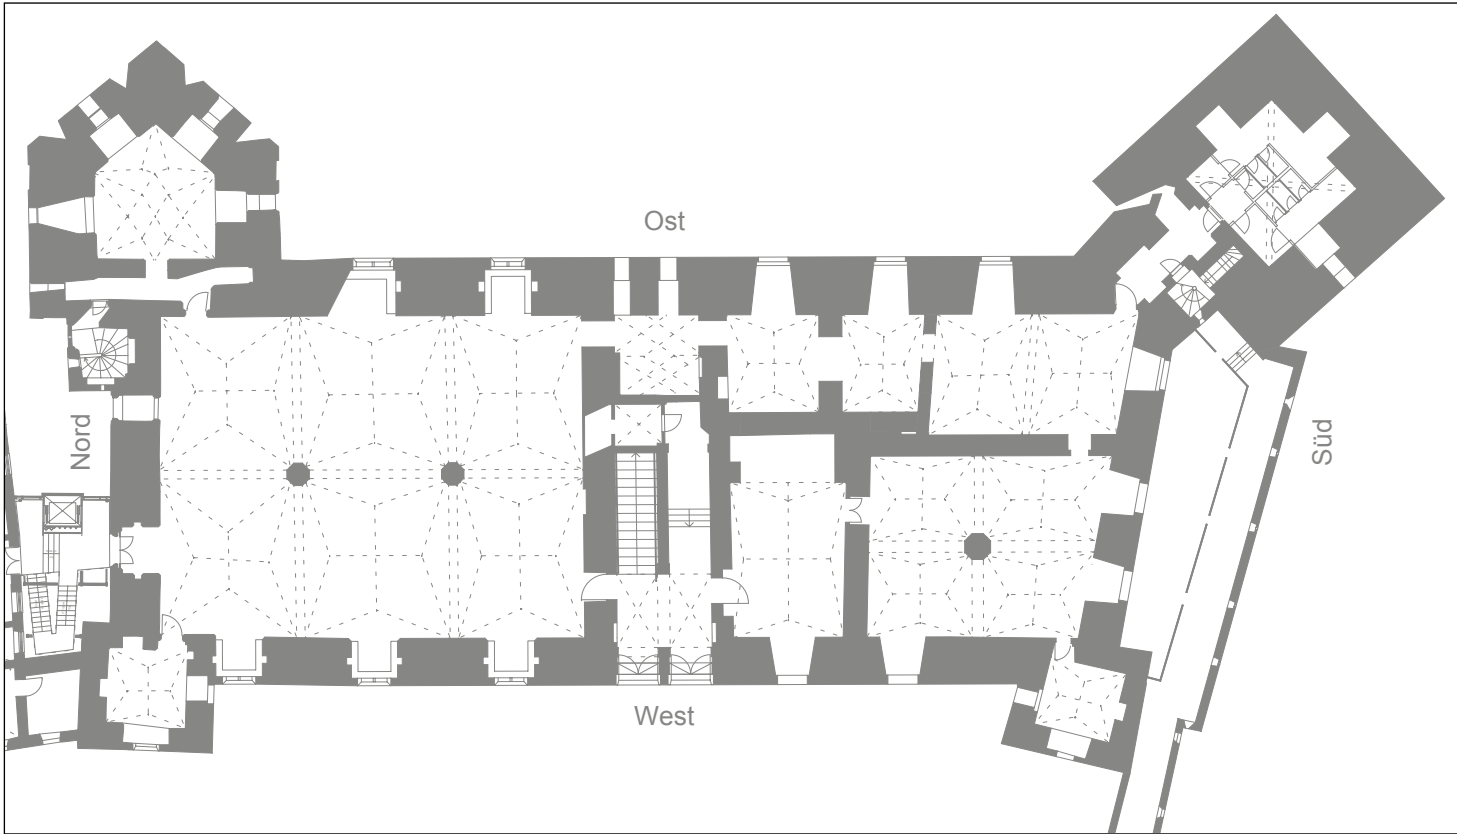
Grundriss des Erdgeschosses des Neuen Schlosses Ingolstadt
